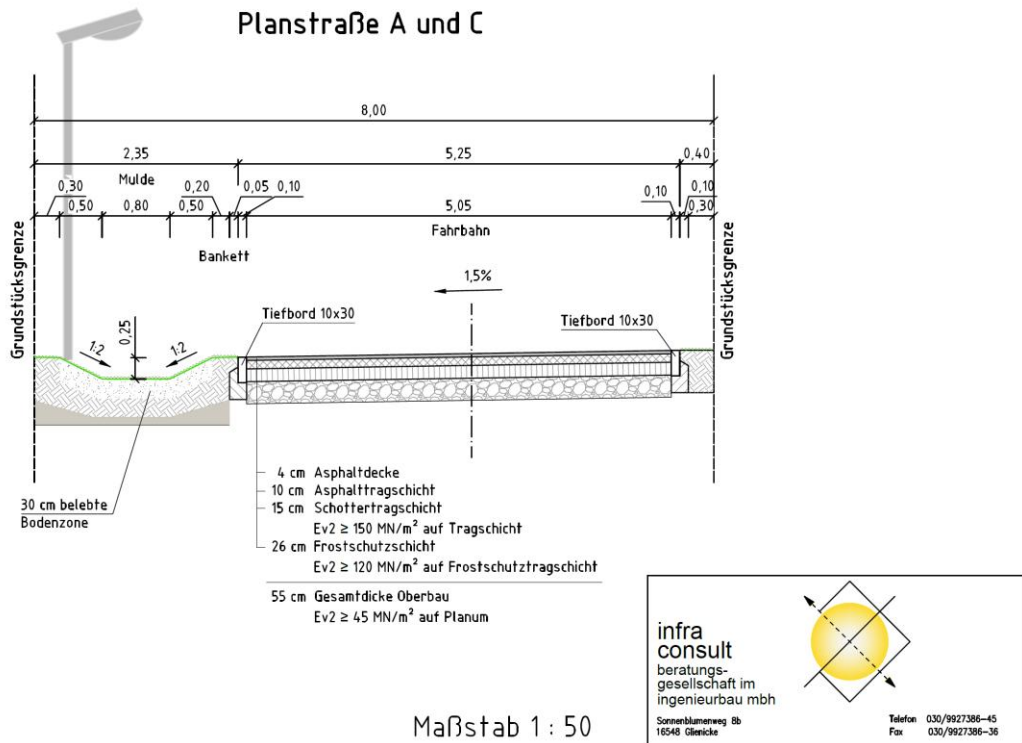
Planung Straßenbau Planstraße B, C, D (Infraconsult Beratungsgesellschaft im Ingenieurbau GmbH, September 2025)
